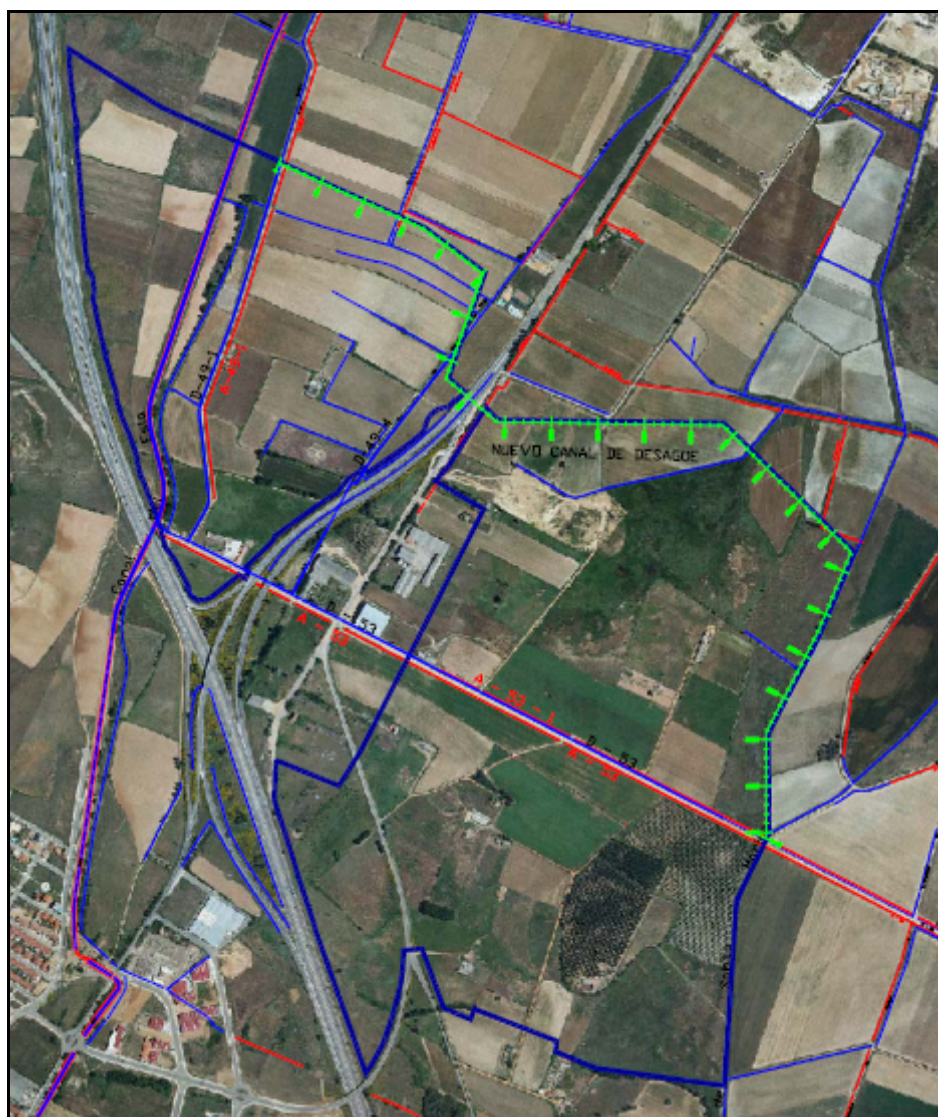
Nuevo canal perimetral de interceptación de los desagües secundarios D-49-1 y D-49-4.
